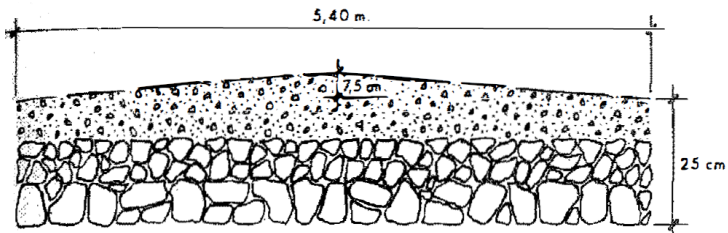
Estructura de calzada propuesta por Pierre Marie Jérôme Trésaguet en 1775
